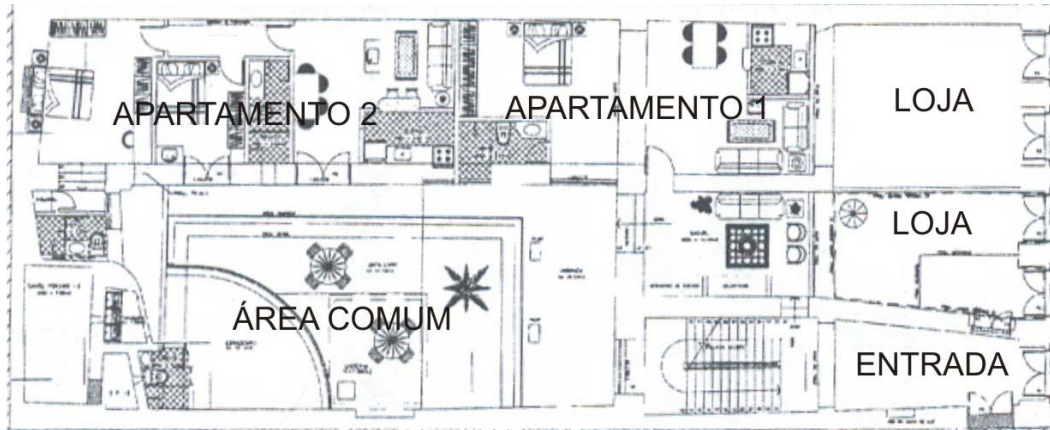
Sobrado à rua do Giz, 117 – Planta baixa do térreo (LIMA et al, 2004, p. 129, adaptado pela autora).
